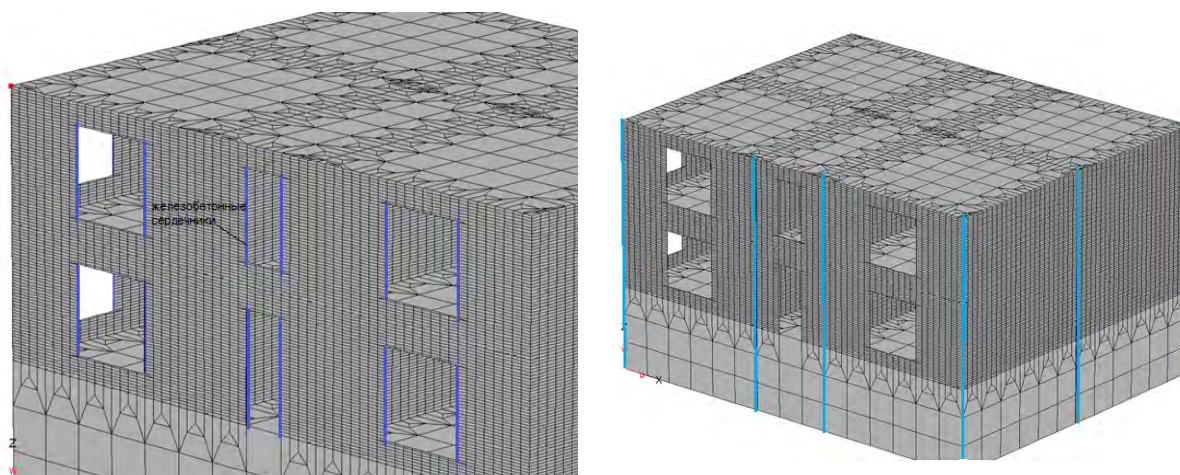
Расчетные схемы здания: схема № 1 – с обрамлением дверных и оконных проемов железобетонными сердечниками; схема № 2 – с железобетонными сердечниками в углах и местах пересечения стен
